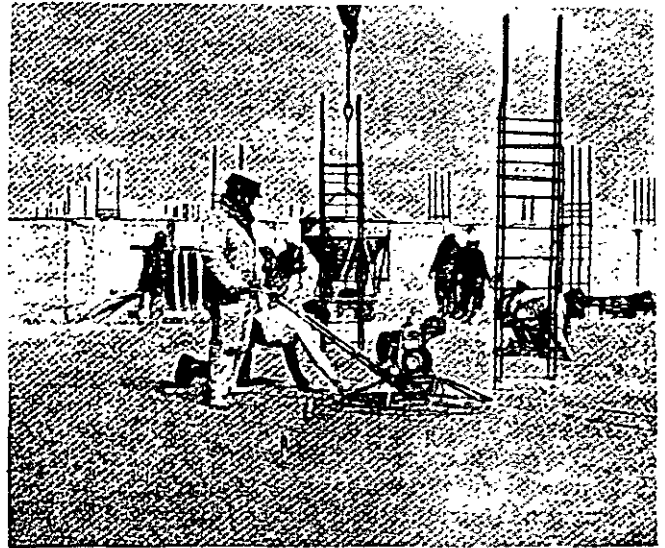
El acabado de la superficie de concreto puede proceder gracias a la colocación de un rompevientos, gracias a que existe el calor adecuado bajo la losa, y a que el concreto tiene un revenimiento bajo.
